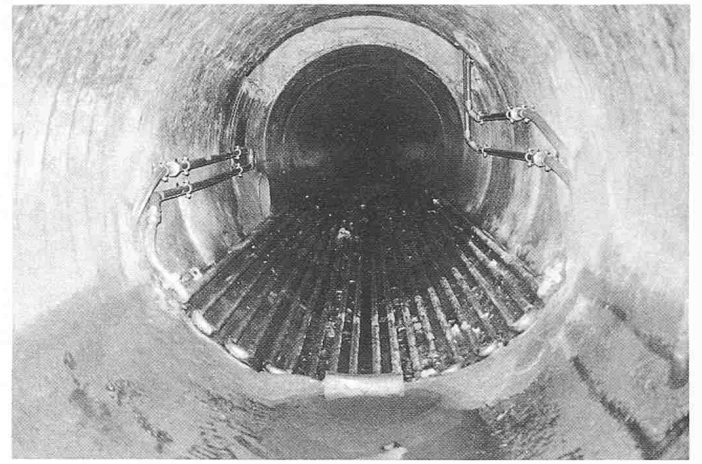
Echangeur de chaleur dans les égouts / Wärmetauscher im Abwasser
